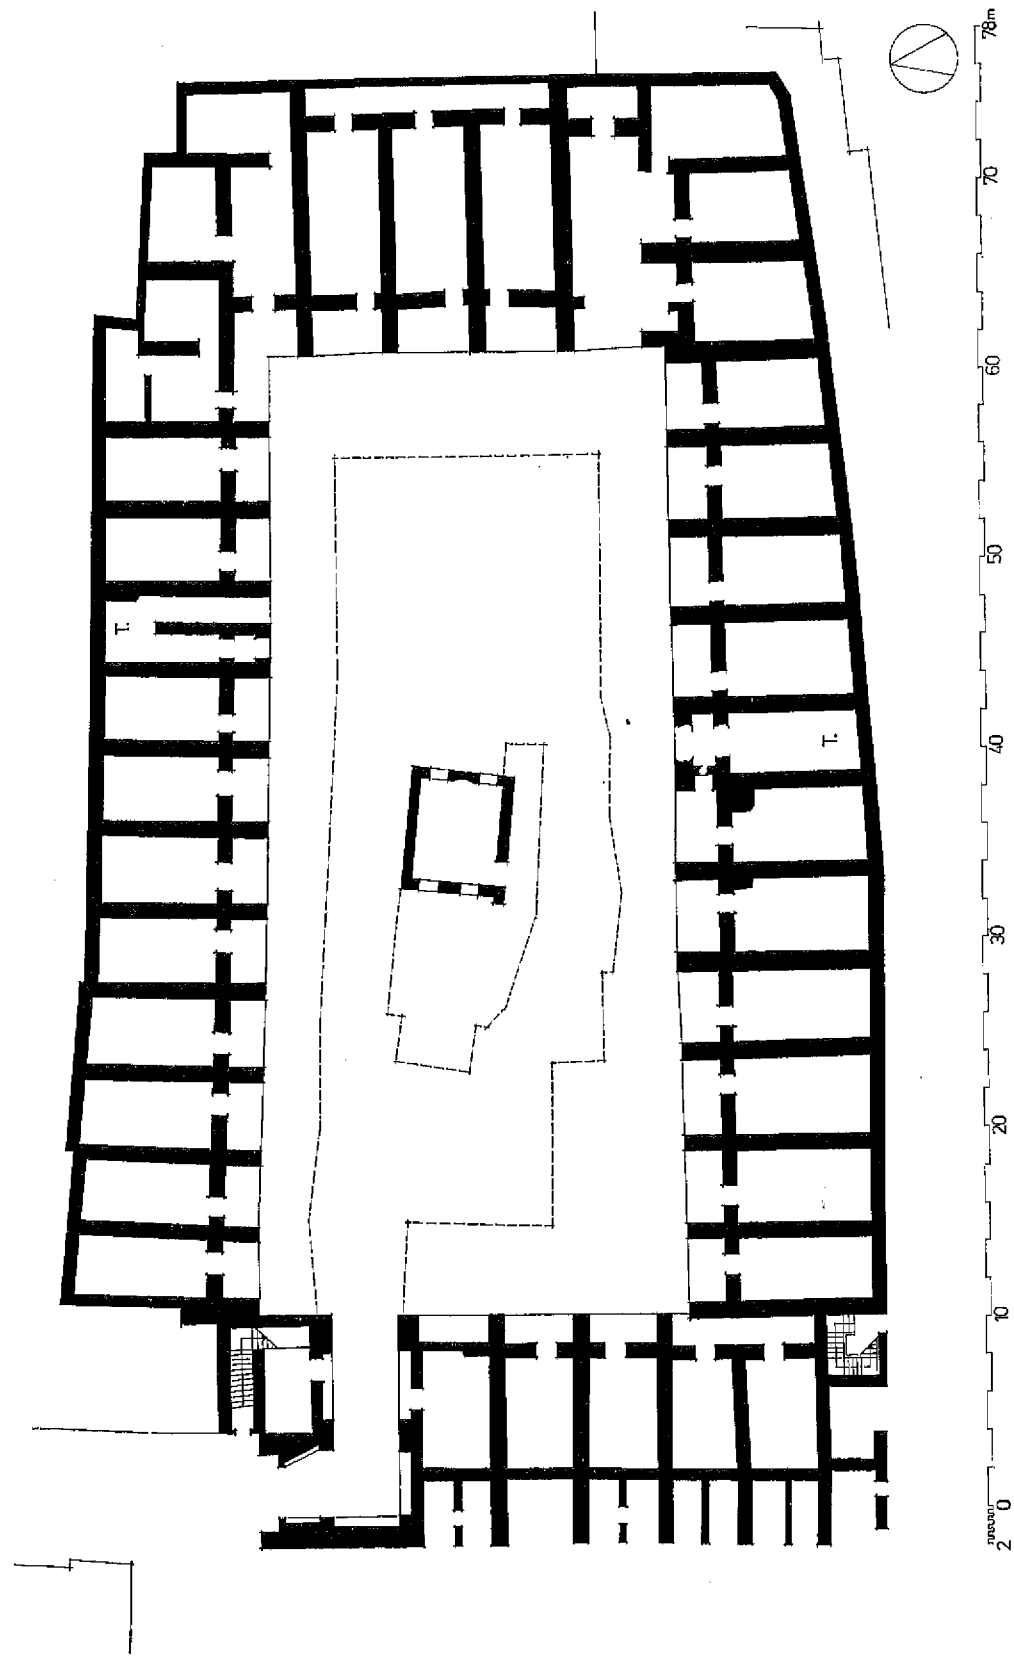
Kairo, Wakalat Du l-Fiqār, Grundriß — Erdgeschoss
